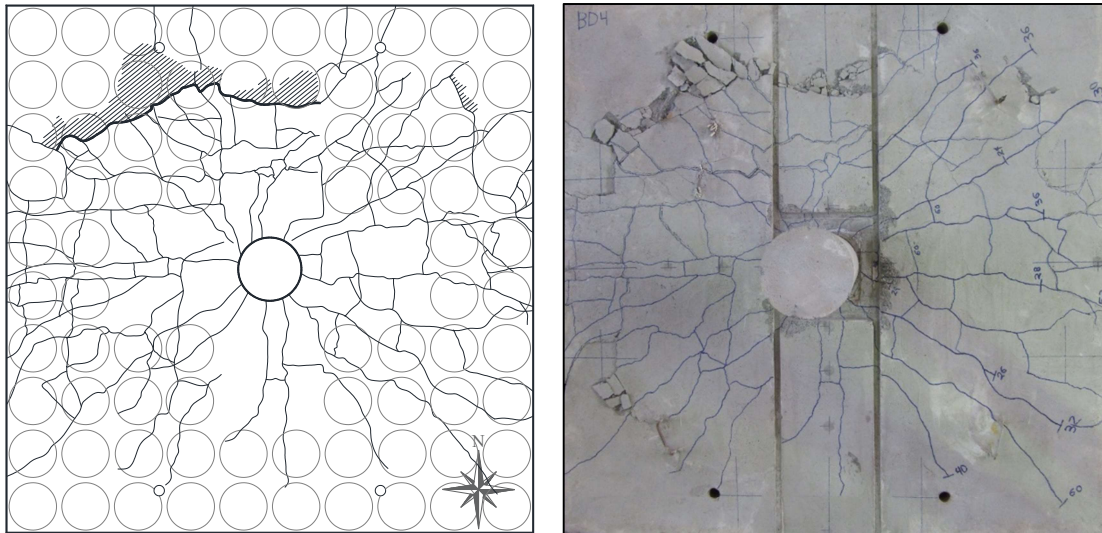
Mapa de fissuração da laje BD4
